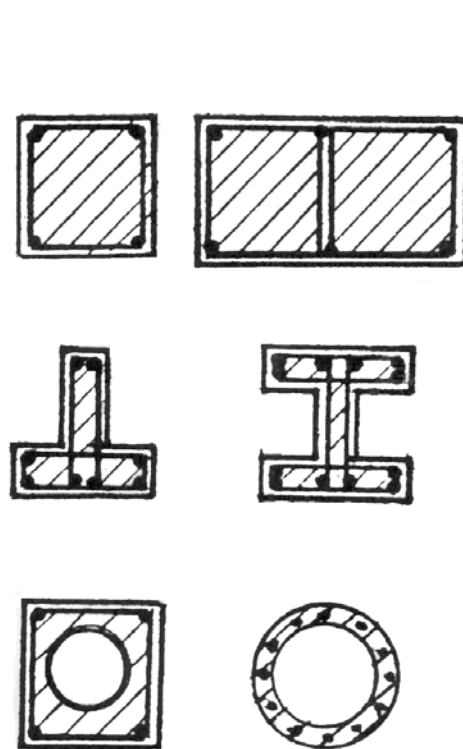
Формы поперечных сечений железобетонных свай: квадратное, прямоугольное, тавровое, двутавровое, квадратное с полостью, круглое
